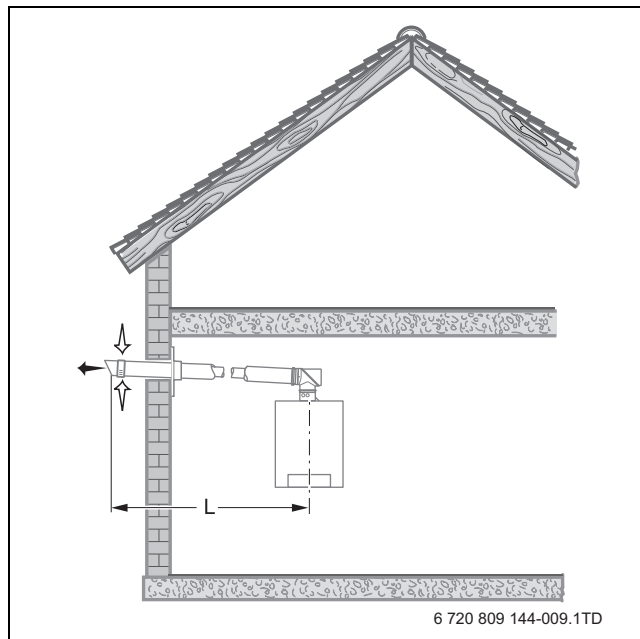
Montagevariante mit dem Bausatz WH/WS (Maße in mm)
